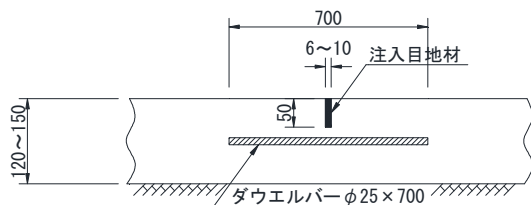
横収縮目地の構造例 (単位: mm) ¹⁾
